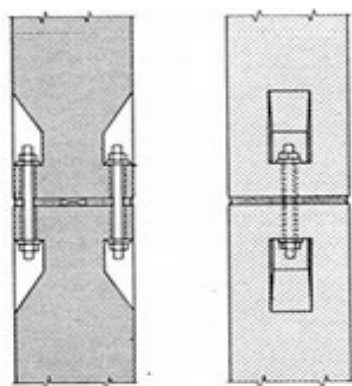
Ligação pilar-pilar com recurso a parafusos (STUPRÉ, 1981).
